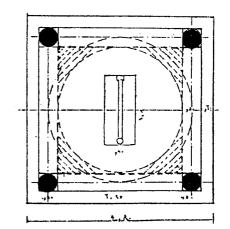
مسقط أفقي لقبة الشيخ الروبي بالفيوم (عن إبراهيم عامر).
